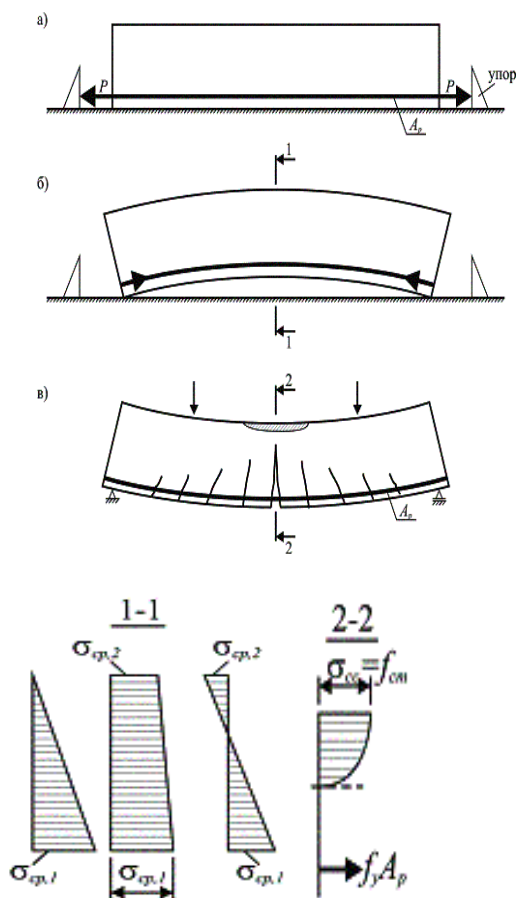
Предварительно напряженная балка при натяжении арматуры на упоры (а), возможные эпюры напряжения в бетоне после отпуска напрягаемой арматуры (б) и в стадии разрушения (в)
